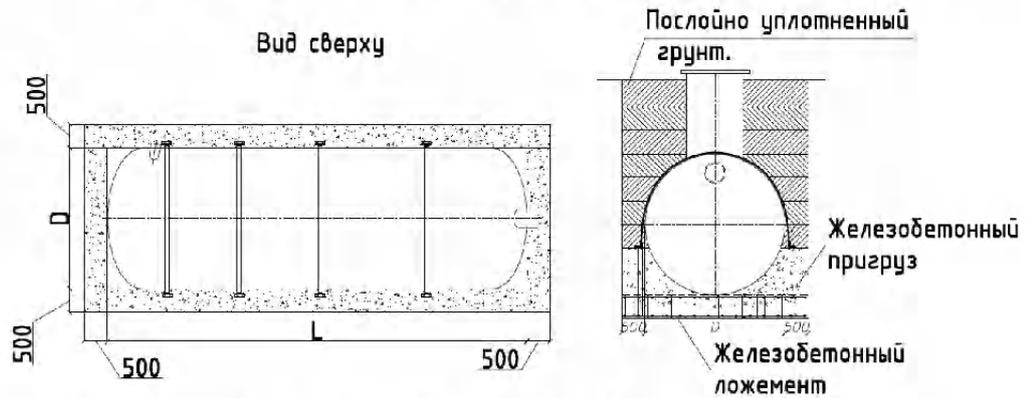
Пример монтажа оборудования при высоком уровне грунтовых вод
